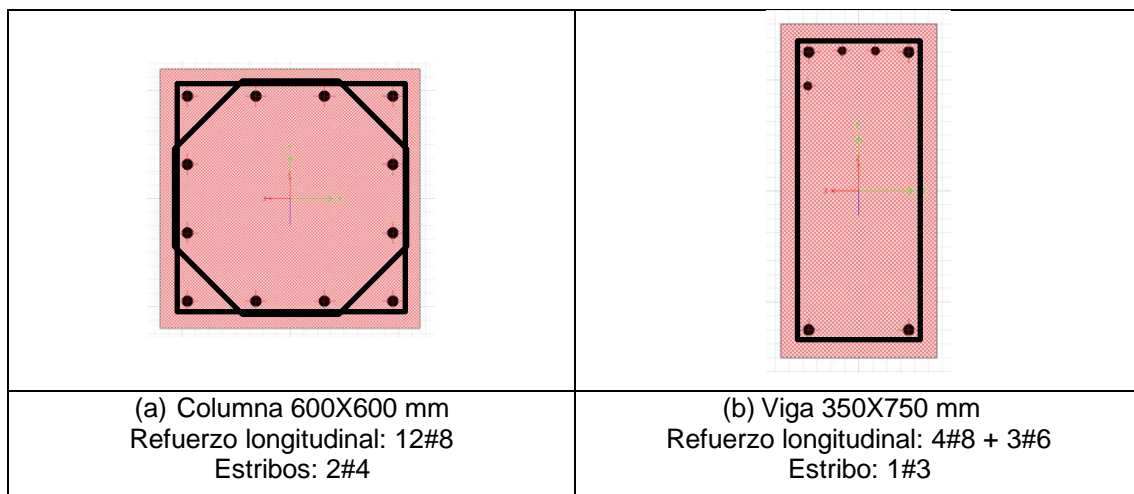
Edificio de referencia: (a) Armadura típica en base de columnas, (b) Armadura para máximo momento en vigas
